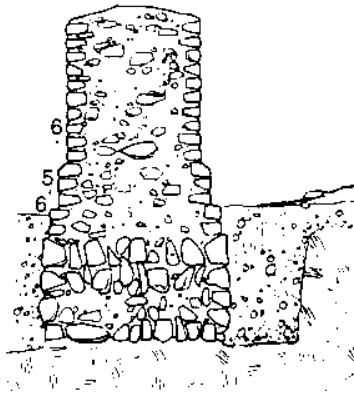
Croquis de sistema constructivo de muro y cimentación, el encofrado de materia en bruto en el muro recubiertos por sillares de piedra. Tomado de Pierre-Adam, Jean. 2002
